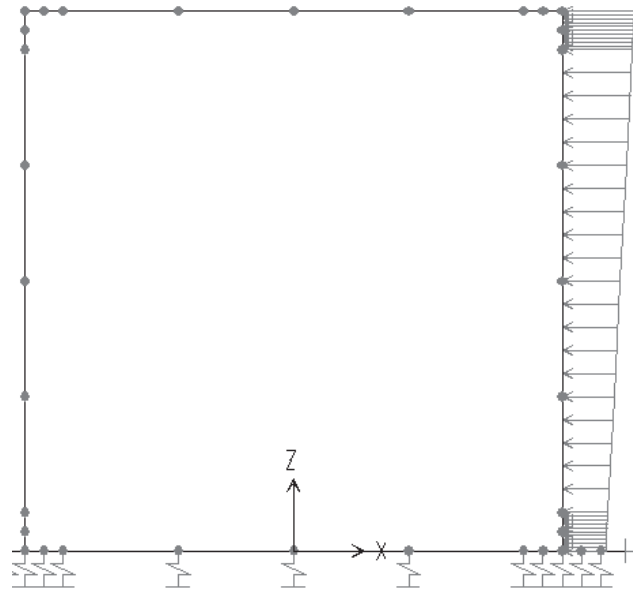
SPINTA DOVUTA DALL’AZIONE VERTICALE DA TRAFFICO SUL PIEDR. DX SQMD
